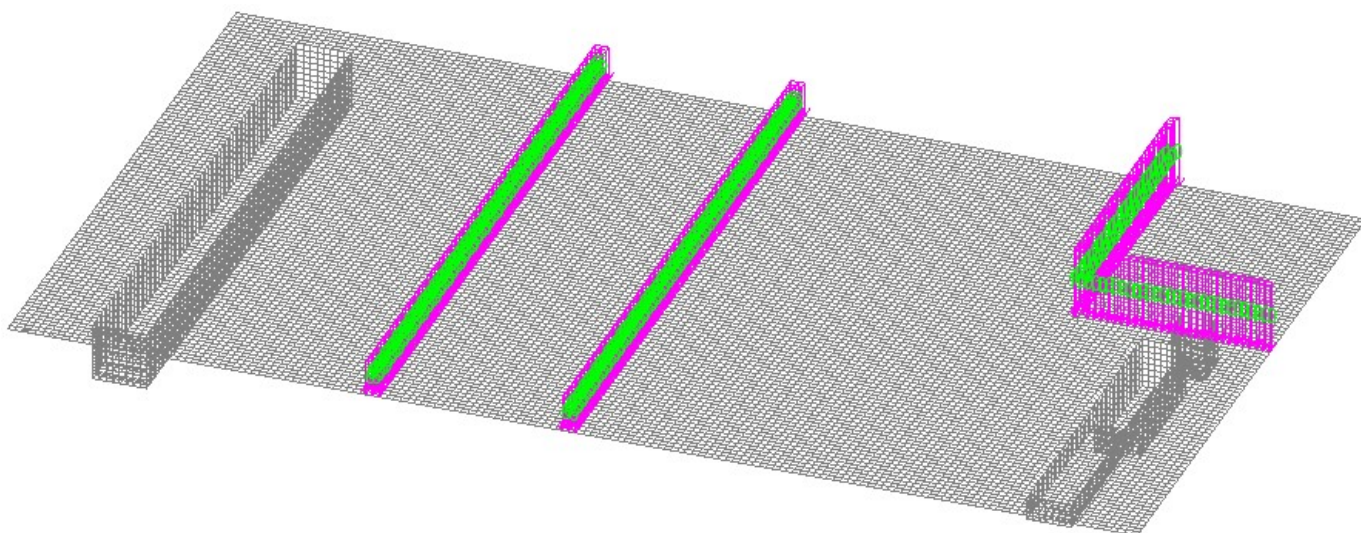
Схема нагрузки, от кирпичных стен
